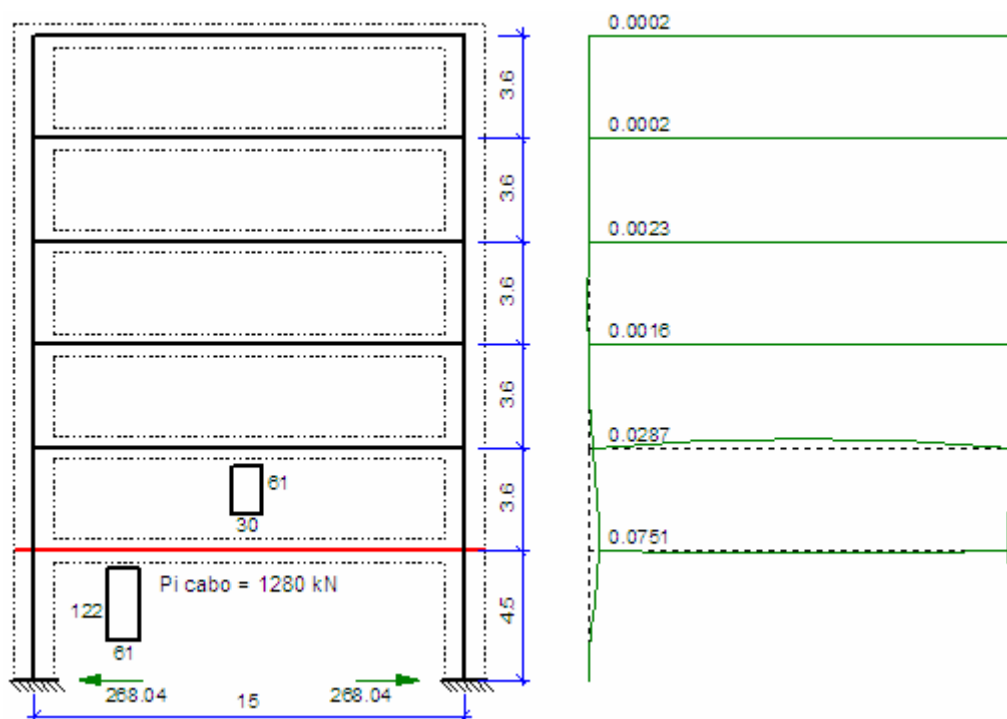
Pórtico com protensão no 1º pavimento - Geometria e deslocamentos
